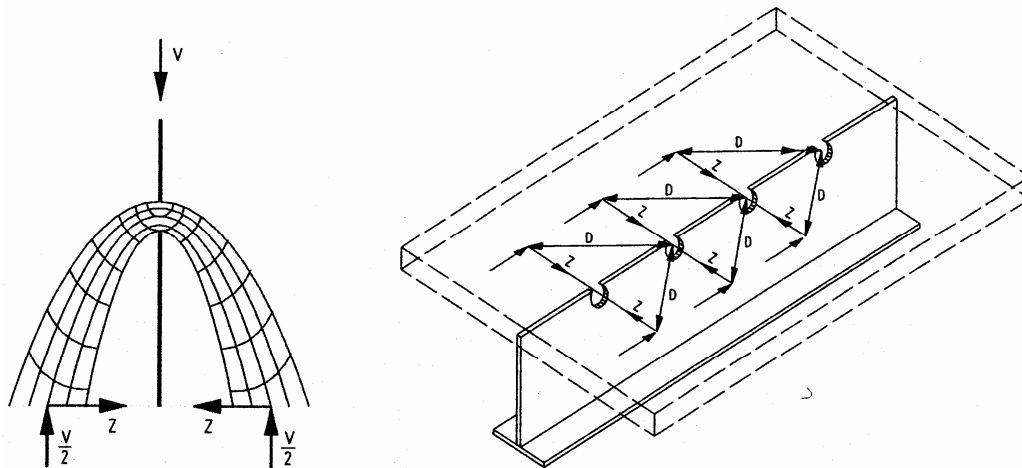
Lastausbreitung in einer Verbundfuge mit Betondübel [MANGERIG, I. (2005)]
